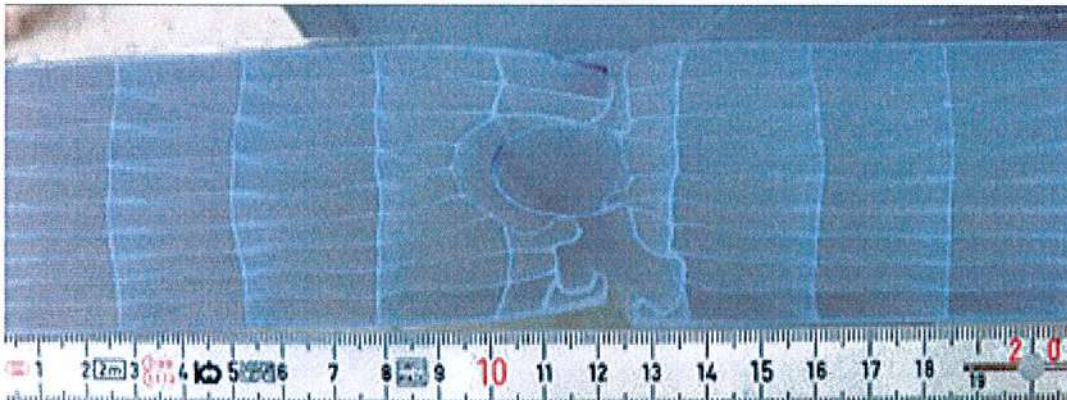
Plattenstoss Platte 2550-10, beschossene Aussenseite (oben)
